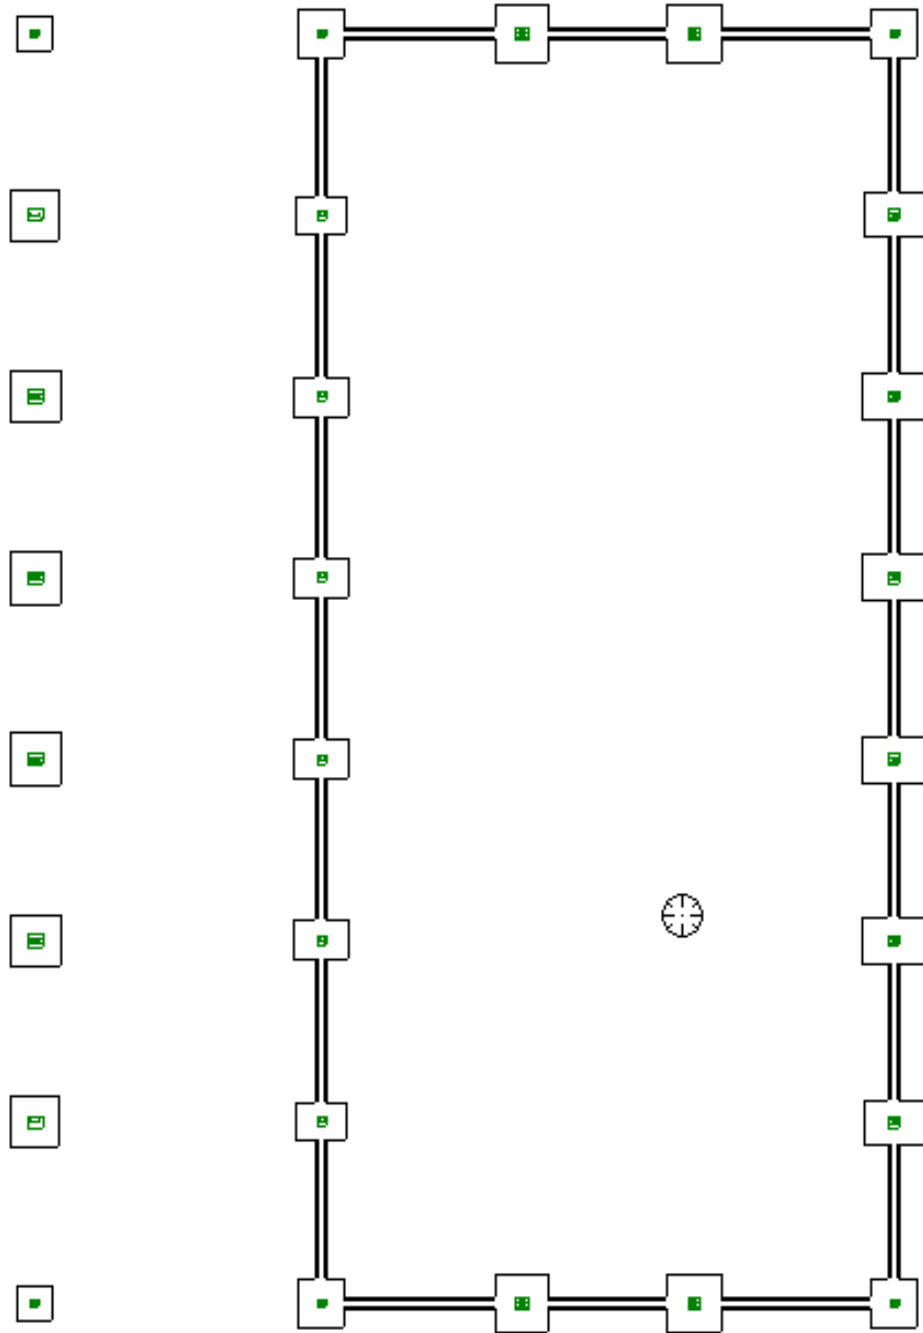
Detalle de la cimentación del conjunto nave-porche.
